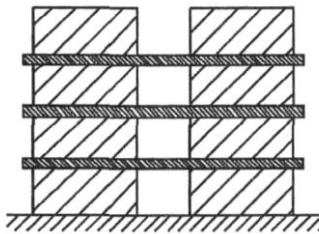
Збірні будівельні системи. Тип 3 - Збірні або бетонні стіни, об'єднані сталевими або складеними балками.
